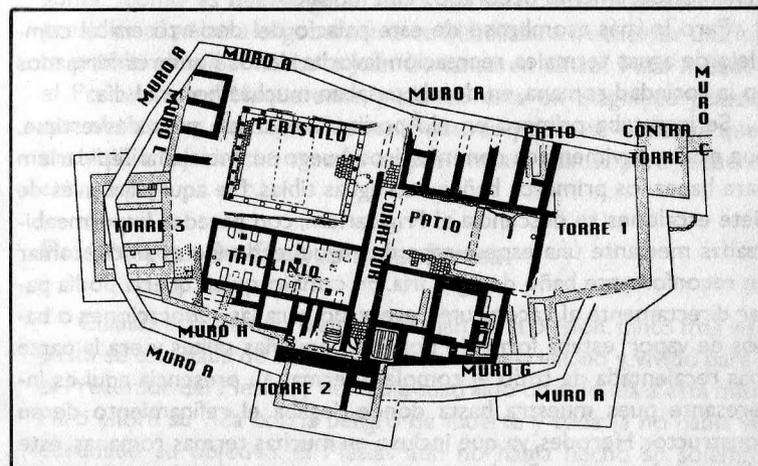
La fortaleza-palacio de Maqueronte, construida sobre la cima de la montaña. Tenía 100 m de largo y 60 m de ancho. Una fuerte muralla (muro A) la protegía en caso de ataque. Estaba dividida en dos secciones por un corredor central. A la derecha de él estaban las termas. A la izquierda, el comedor, frente a un amplio patio de columnas. Cuatro torres de 30 m de altura la defendían.
